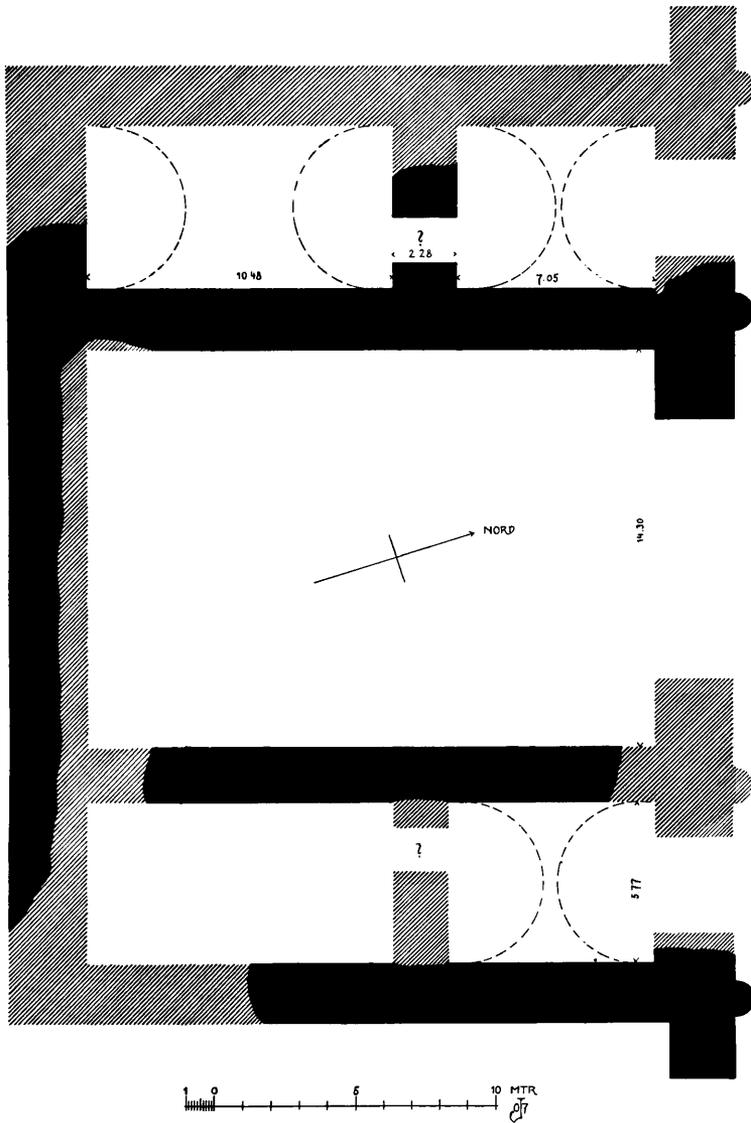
Bau A („Sommerpalast“), Grundriß.
